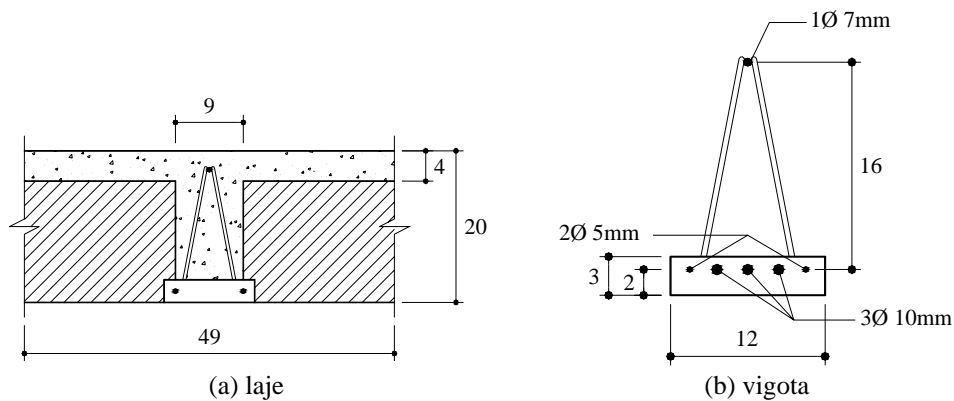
Seção transversal da laje com vão grande (dimensões em cm)
